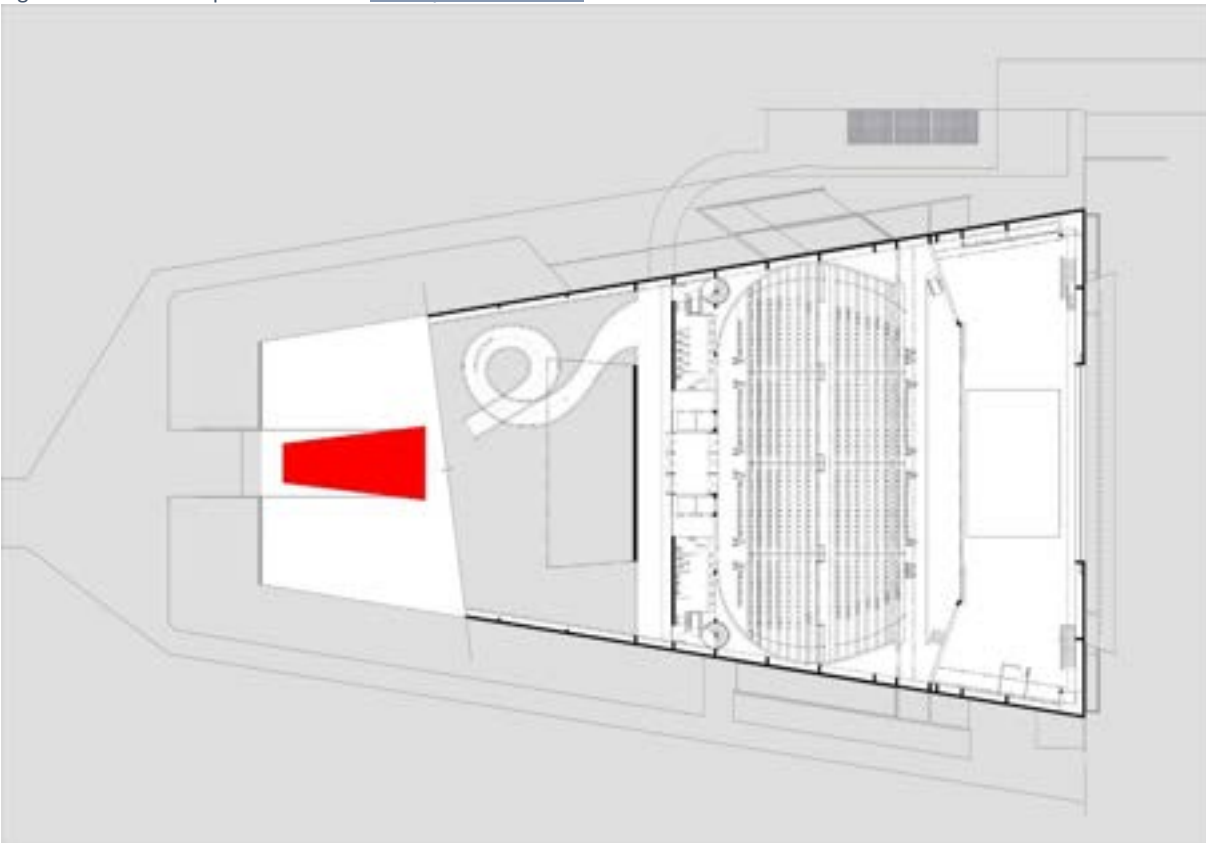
Planta plateia – Fonte: [niemeyer](#) — Bibliocad
